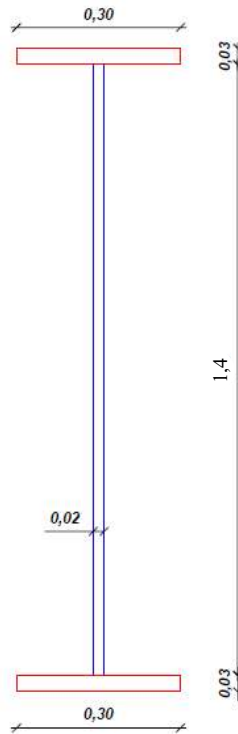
Detalle de Vigas Principales en metros (Autor)
